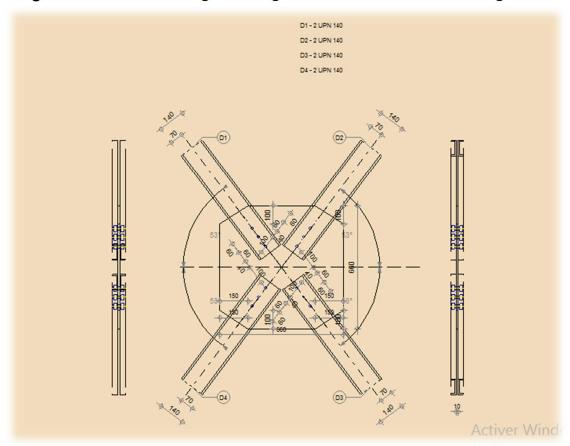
Détail d'assemblage des diagonales doubles cornières avec gousset
